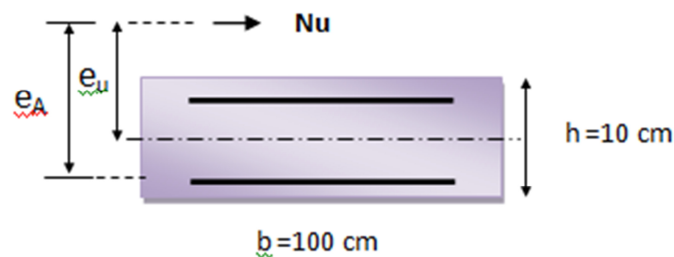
schéma des dimensions pour ferrailage d'acrotère.
